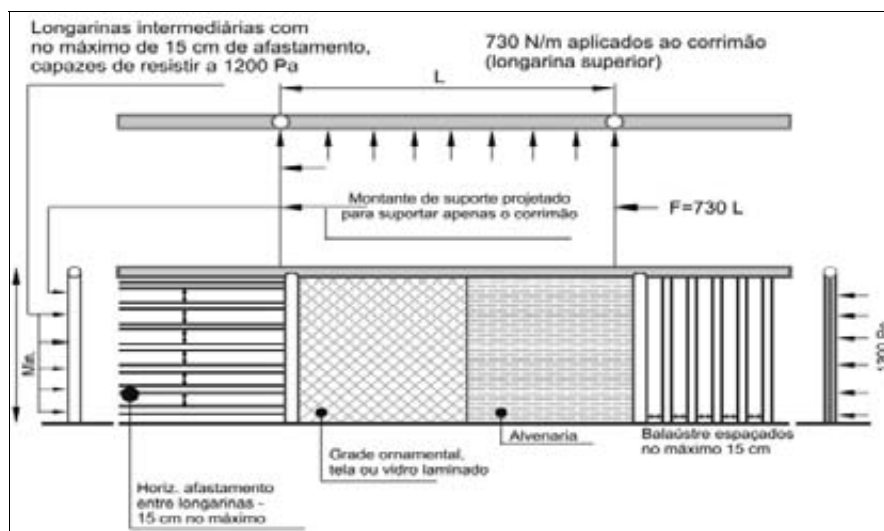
Pormenores construtivos da instalação de guardas e as cargas a que elas devem resistir
